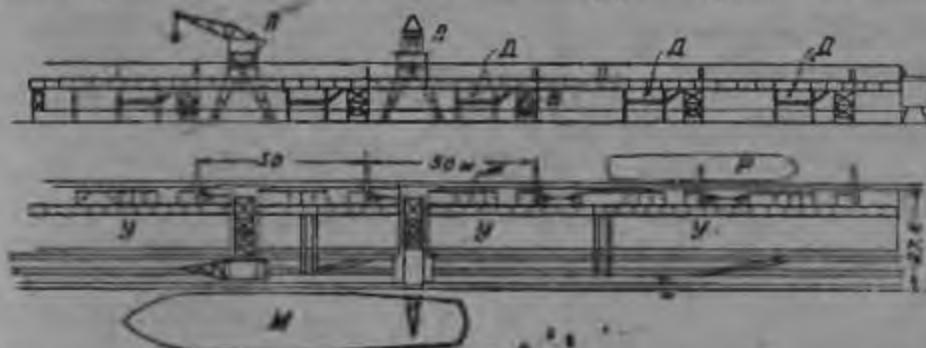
Фасад мола в рыбачьем порту Лориан (см. рис. 254) с оборудованием для перегрузки угля.
